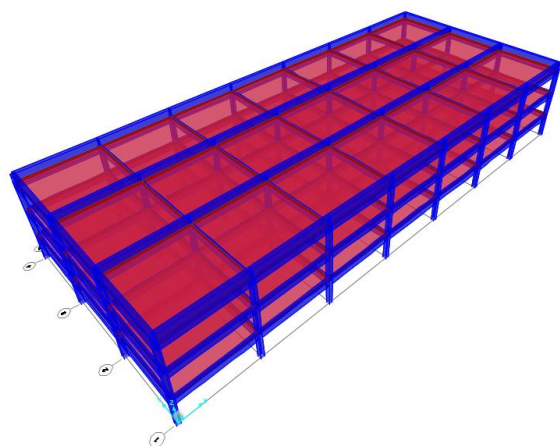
Vista 3D del modelo en SAP2000 de un edificio con vigas de refuerzo en cubierta.
